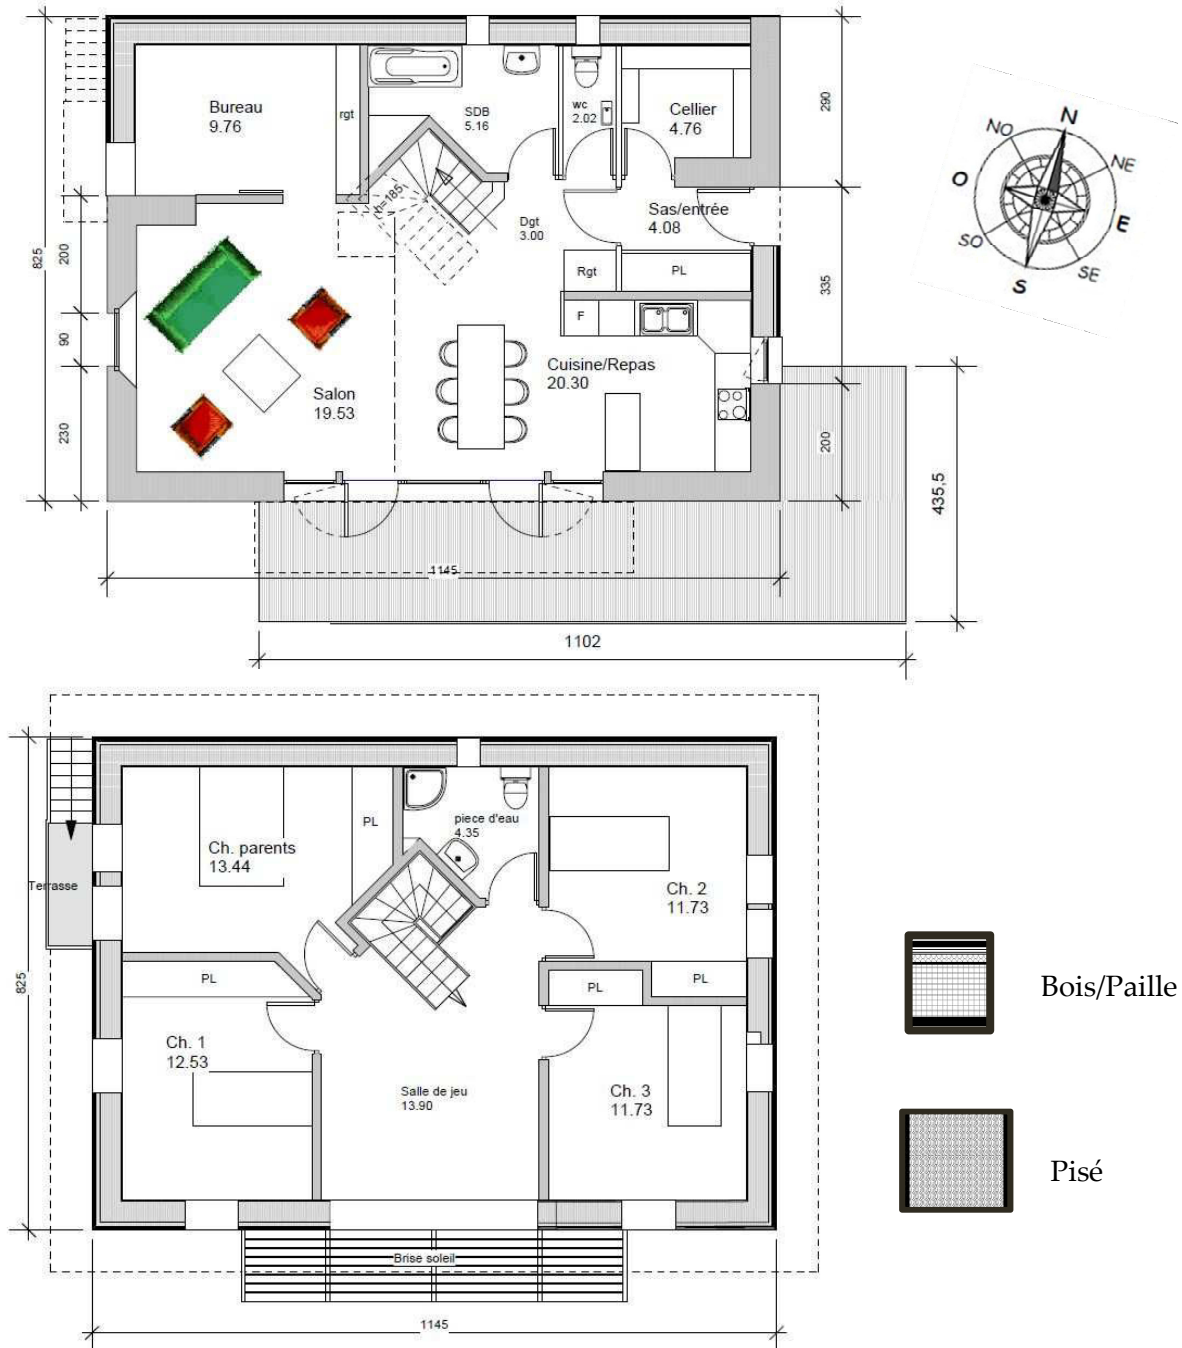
Plan du rez-de-chaussée (en haut) et de l'étage (en bas) de la maison étudiée dans cette thèse à St Antoine l'Abbaye. Jérôme Boucq Architecte
